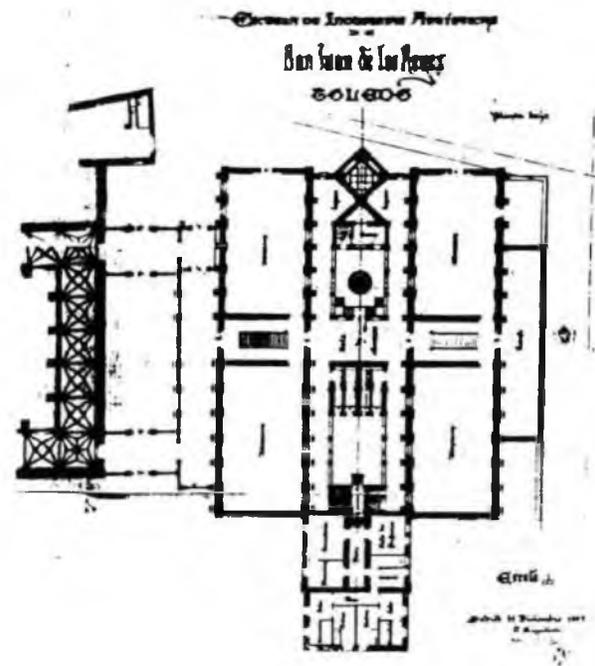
Planta principal y planta del Monasterio de San Juan de los Reyes.
